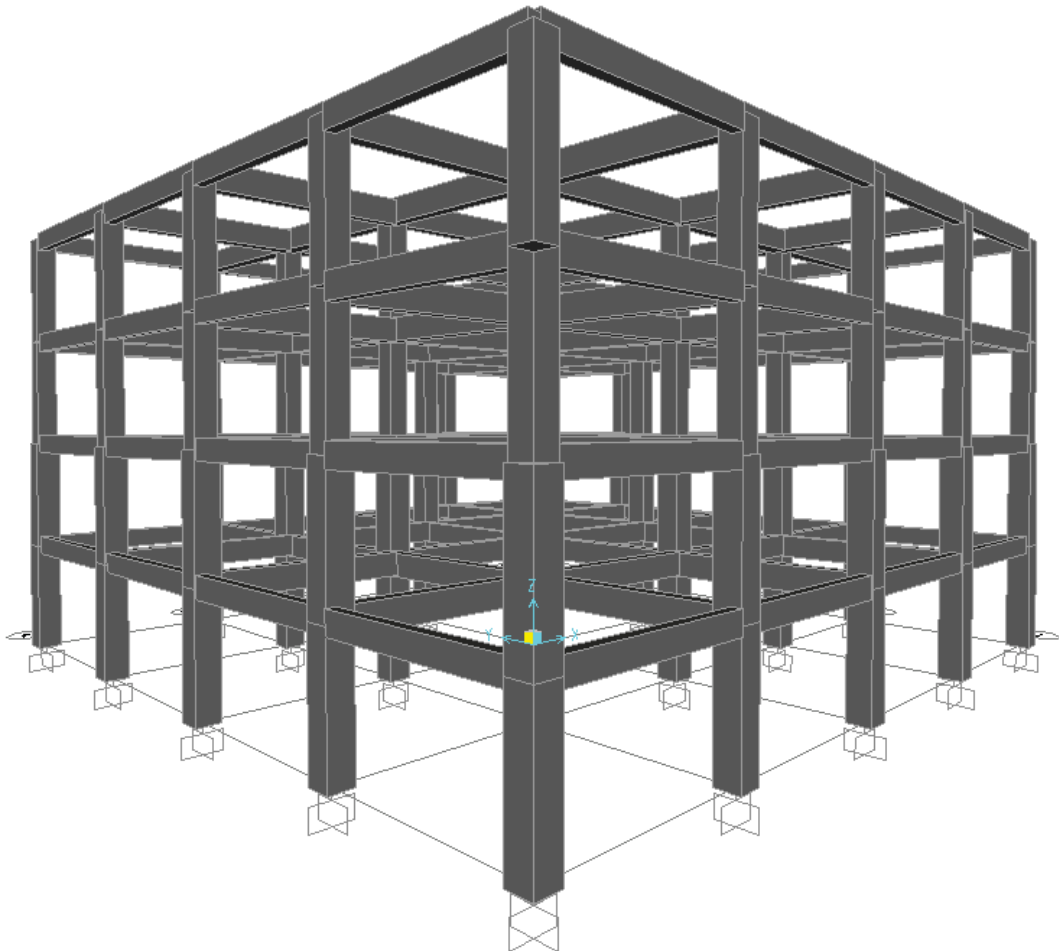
Modelo 3D del edificio de concreto (SAP2000).
